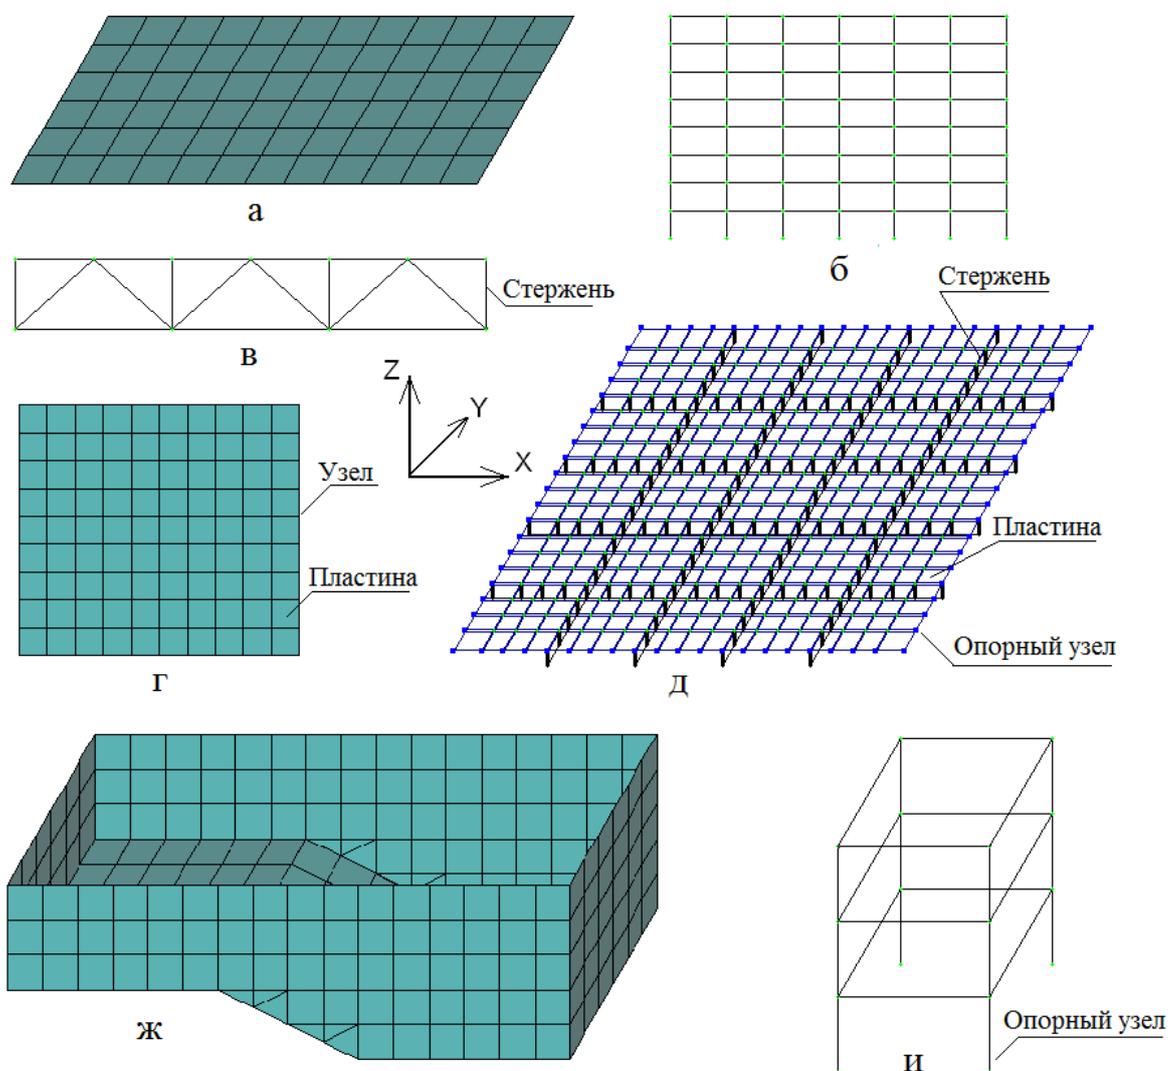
Расчетные схемы: а — плиты перекрытия; б — поперечной рамы здания; в — фермы; г — стенки; д — балочного перекрытия; е — бассейна; ж — объемной рамы здания
